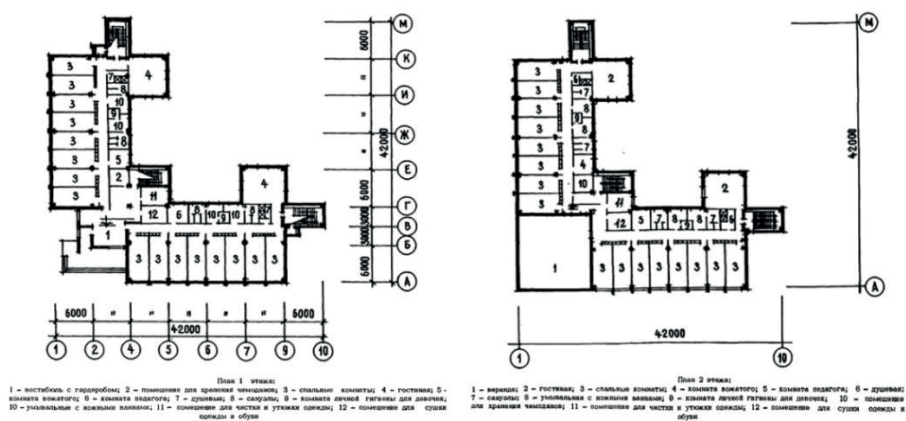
2-ух этажный спальный корпус на 160–140 мест
